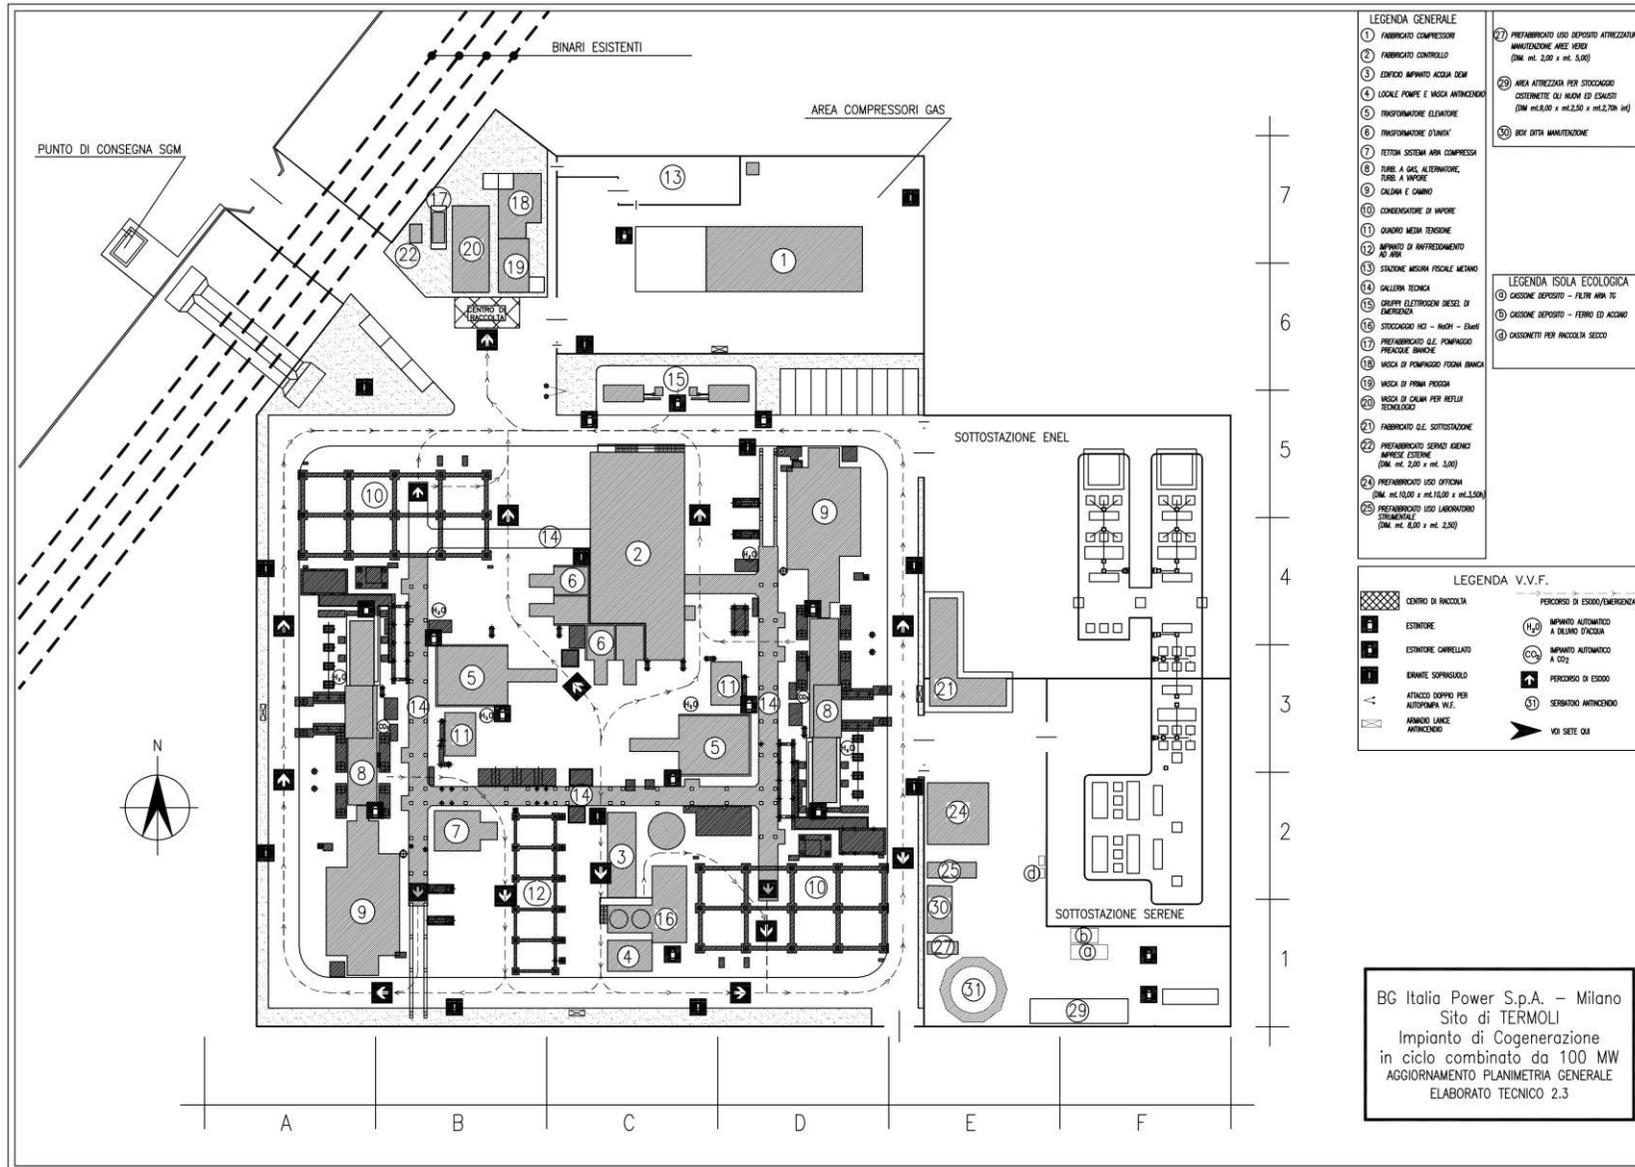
planimetria generale dell'installazione: assetto "ante operam"
